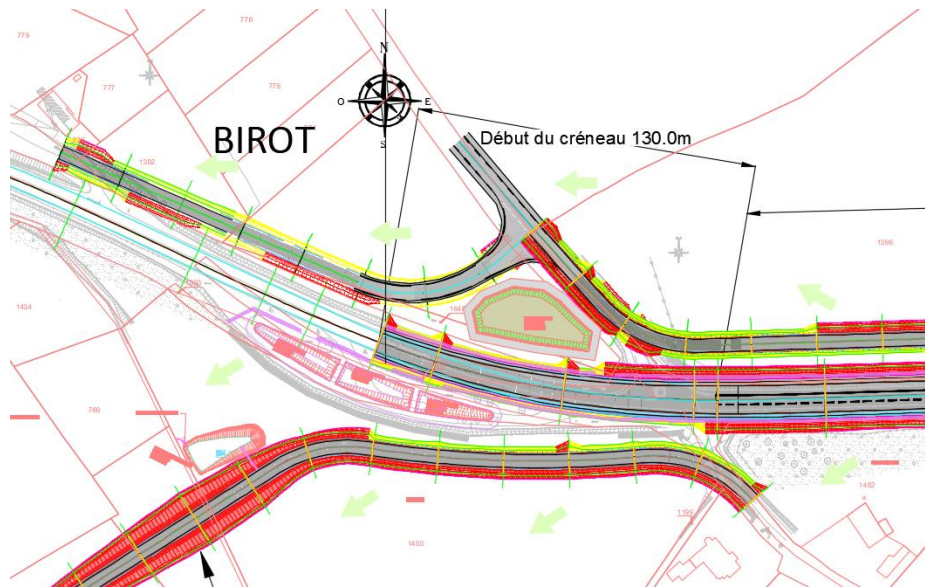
plan de détail de la sortie du giratoire des Fontenelles à 2 voies
